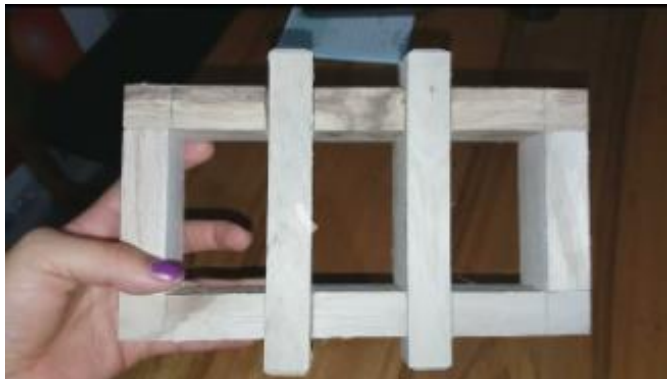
Molde en madera para la elaboración de bloques de mampostería
